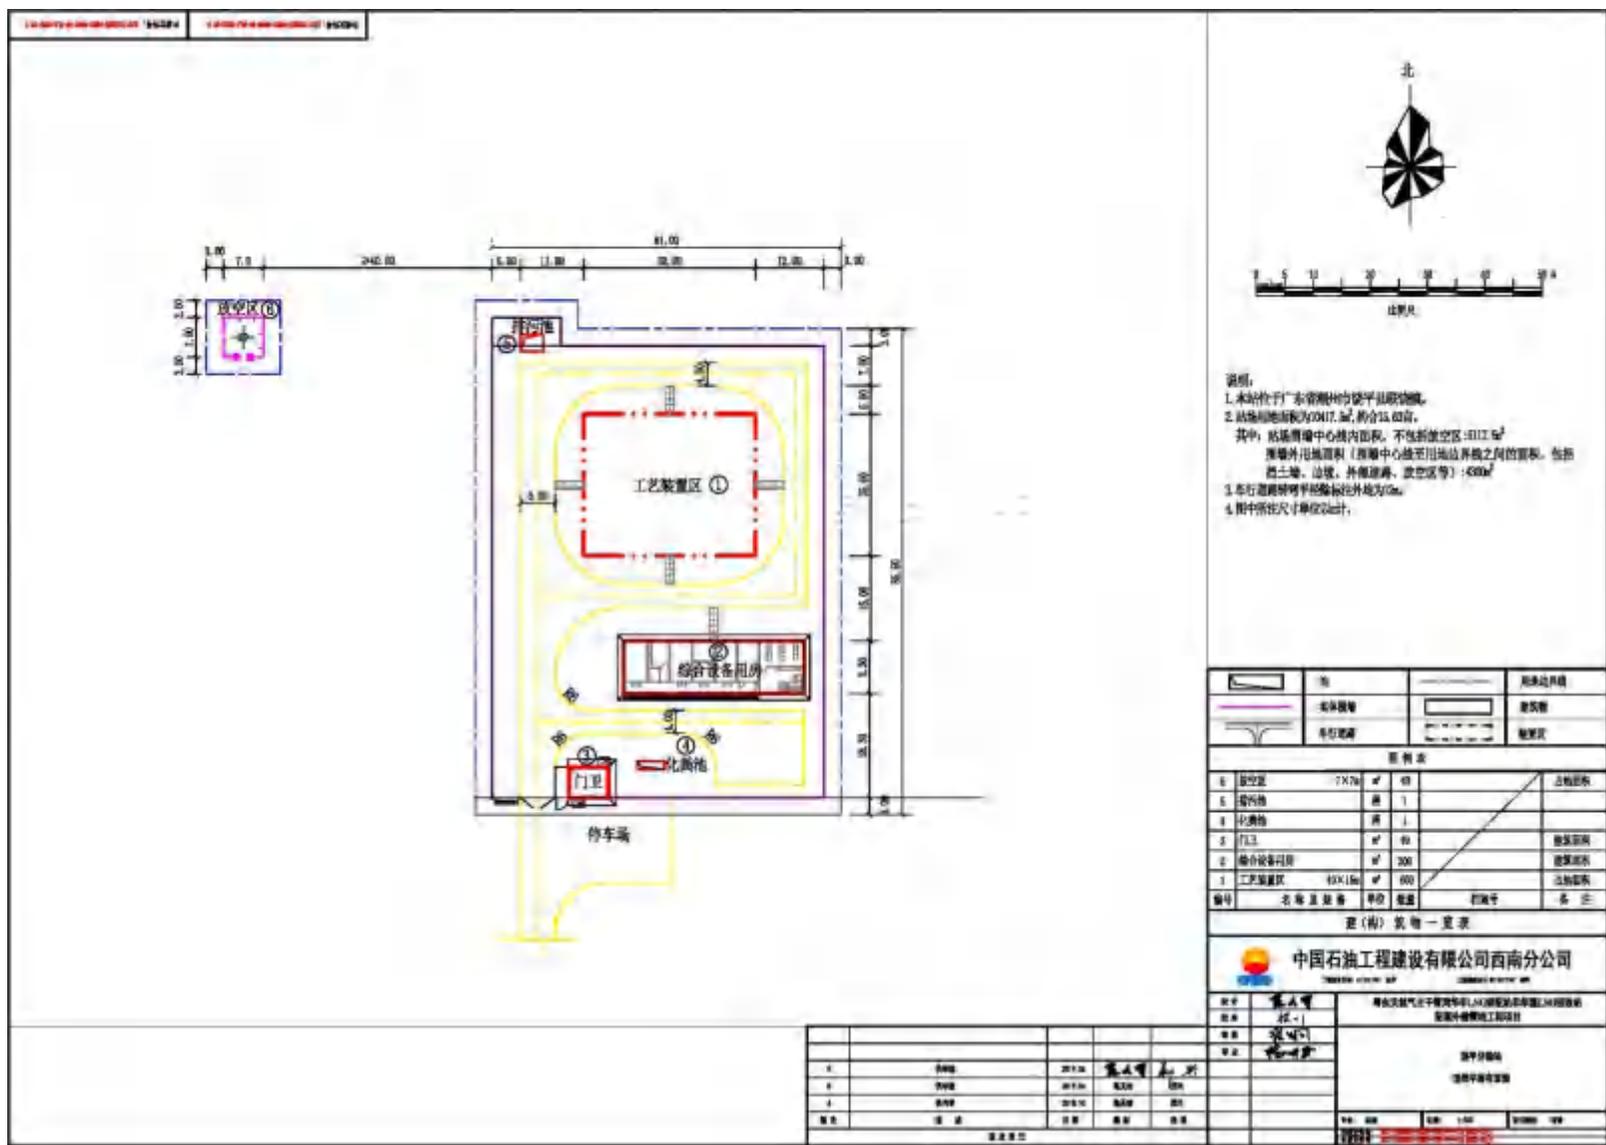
(1) 饶平分输站平面布置图 (环评阶段)
